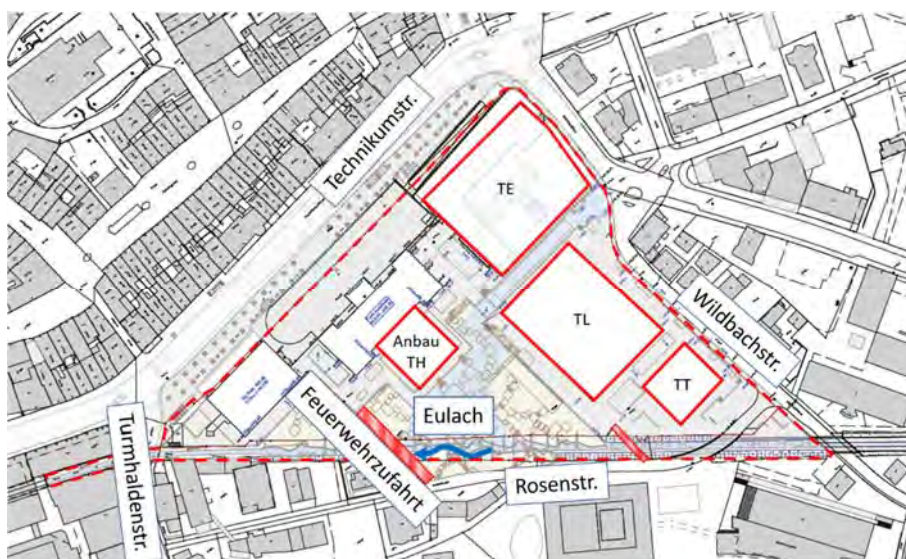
Projektperimeter (rot, gestrichelt) und Lage der Neubauten (rot). Schraffiert dargestellt ist zudem die Lage der beiden Brückenneubauten.
